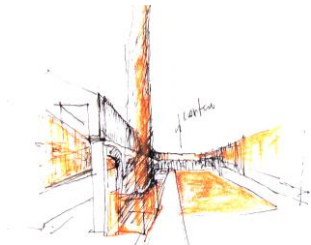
Chaminé cerâmica, e adições em estruturas metálicas revestida por chapa perfurada em alumínio
